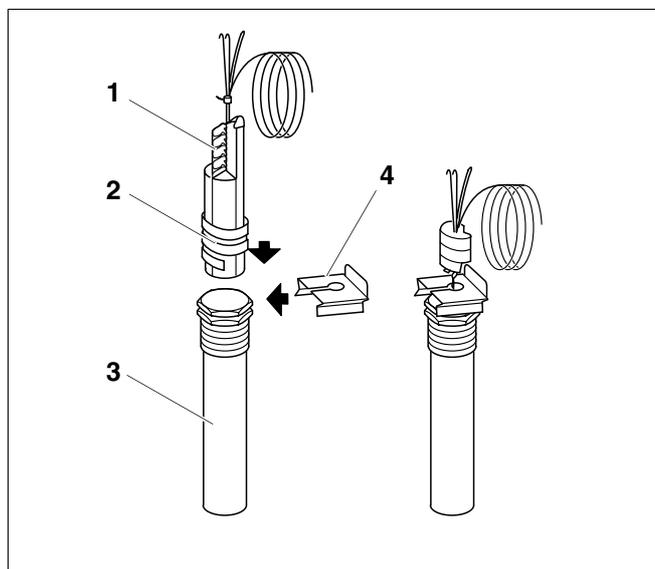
Tubi capillari con sonde e pozzetto ad immersione
